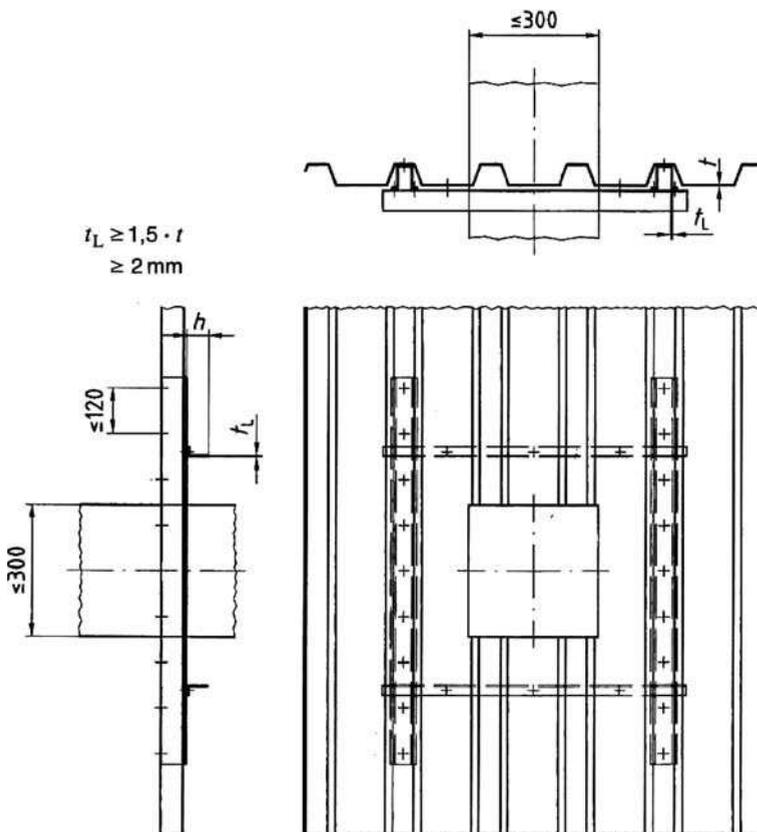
Auswechslung an einer Öffnung im einschaligen Dachaufbau
